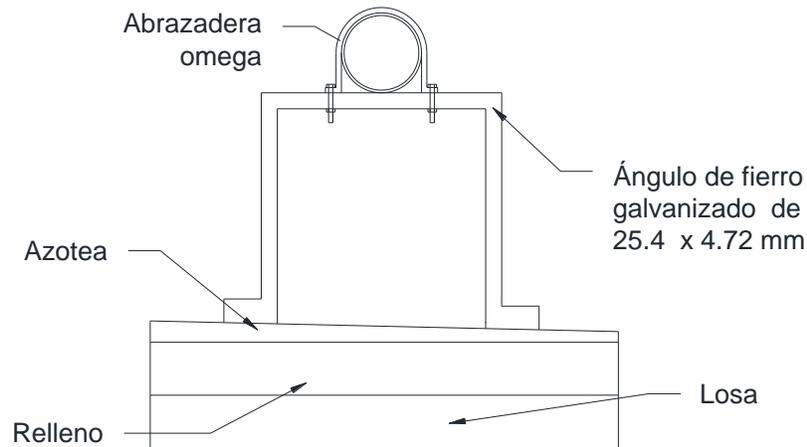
Ejemplo de soporte metálico para tubo conduit por azotea
